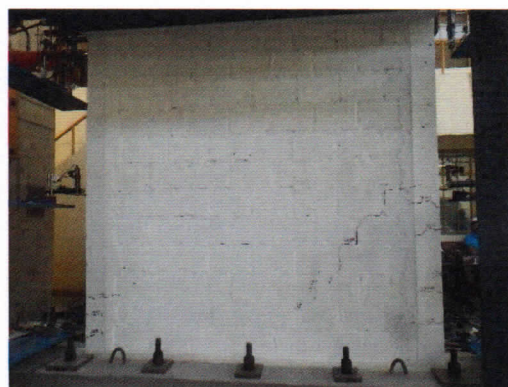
Aparición de grietas diagonales en el mortero en el lado Este de las caras Norte y Sur a una distorsión 1/1500.
